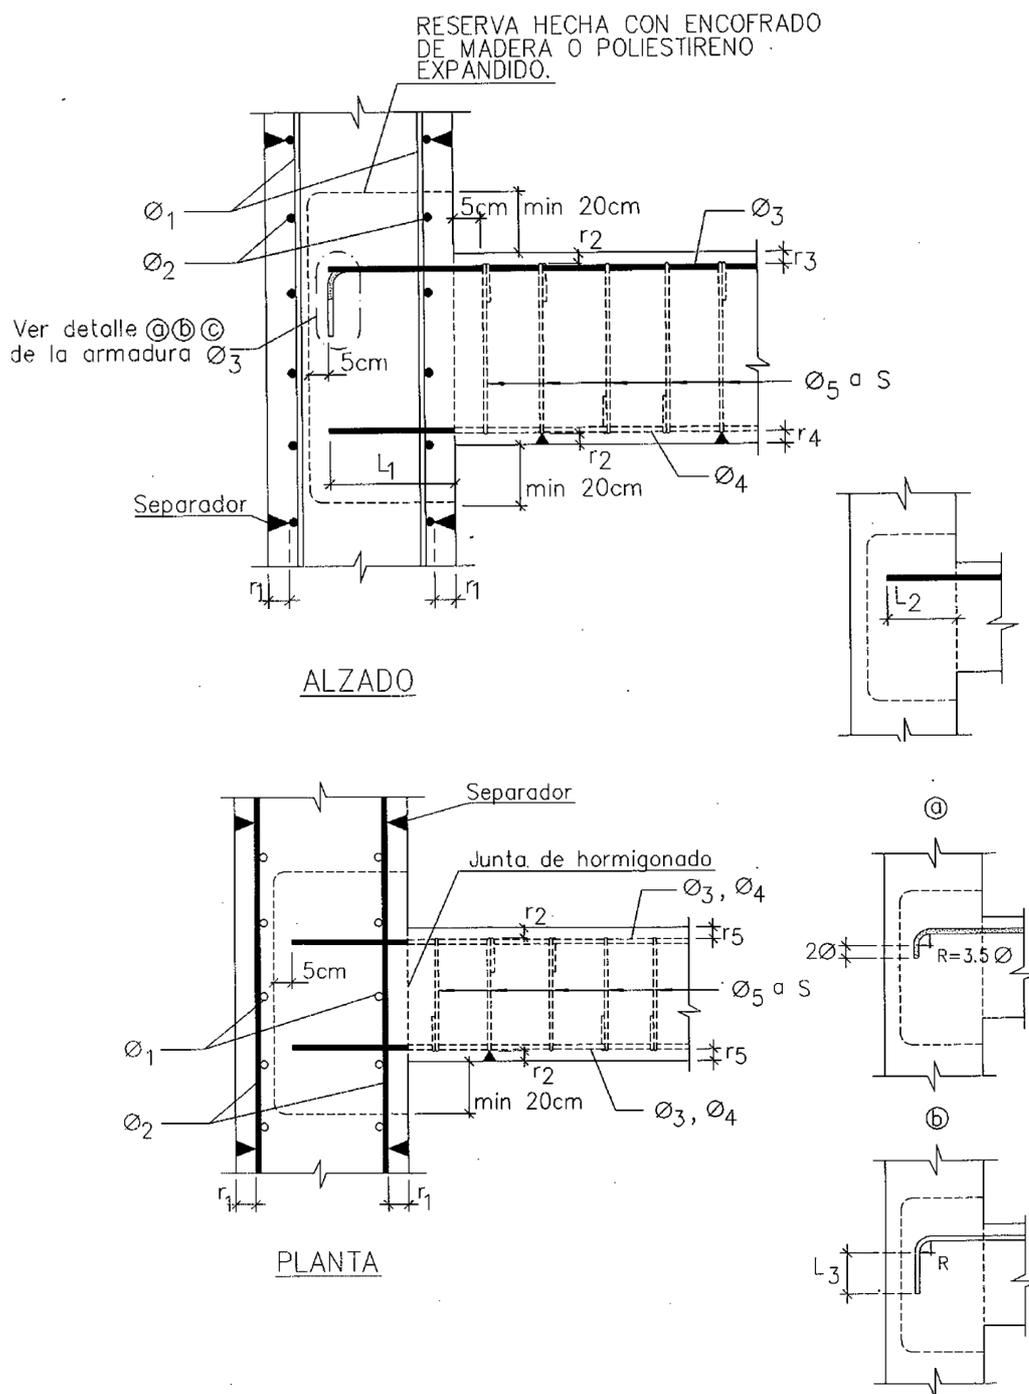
Cajeados puntuales en muro pantalla (Detalles Constructivos J. Calavera, 1993)
